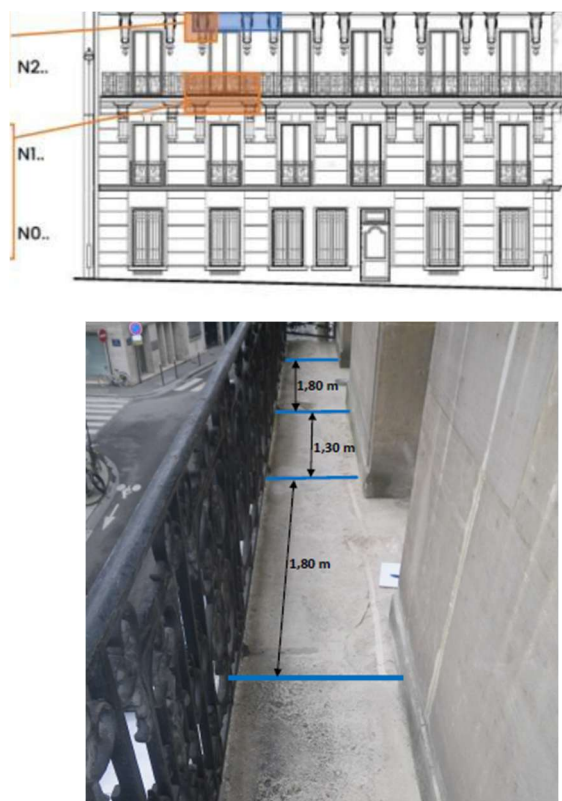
Repérage des joints entre dalles de balcons sur les façades Nord et Ouest. Rapport Rincent BTP
